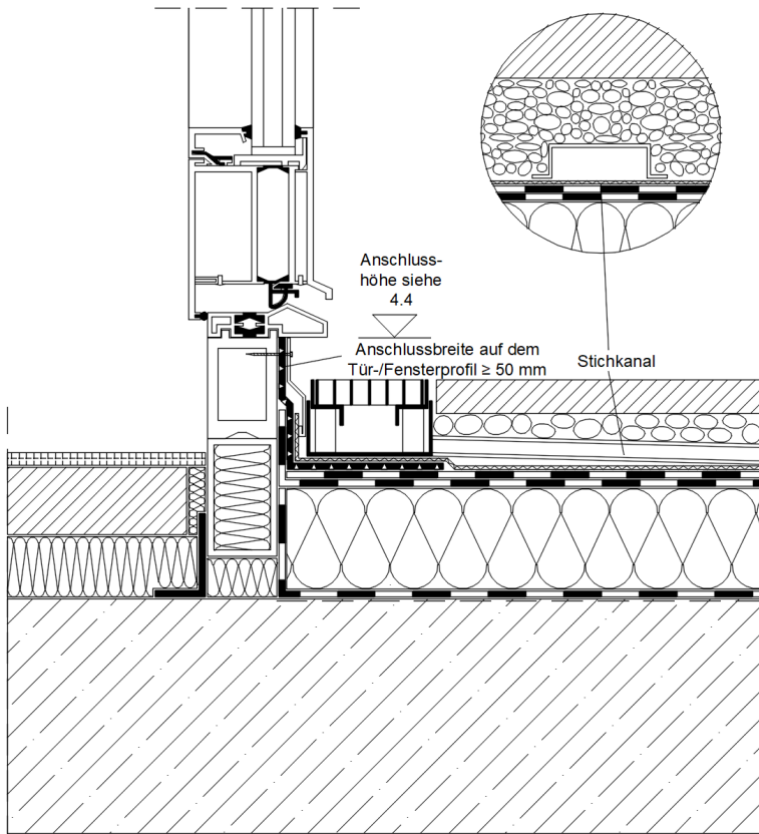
Terrassentüranschluss mit Entwässerungsrinne – Ausführung mit Bitumenbahnen und Flüssigkunststoff mit systemintegrierter Nutzschiene – Anschlusshöhe  $\geq 5$  cm (durchgehende Deckenplatte)
